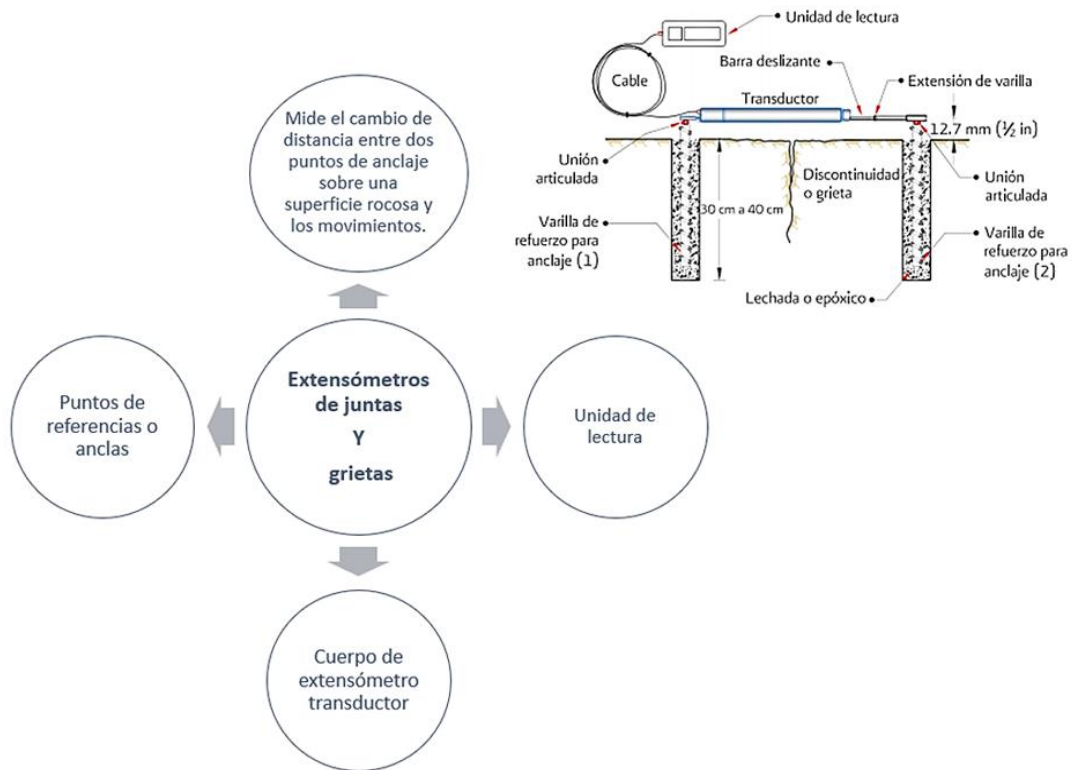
Componentes de Extensómetros de juntas y grietas e instalación.
